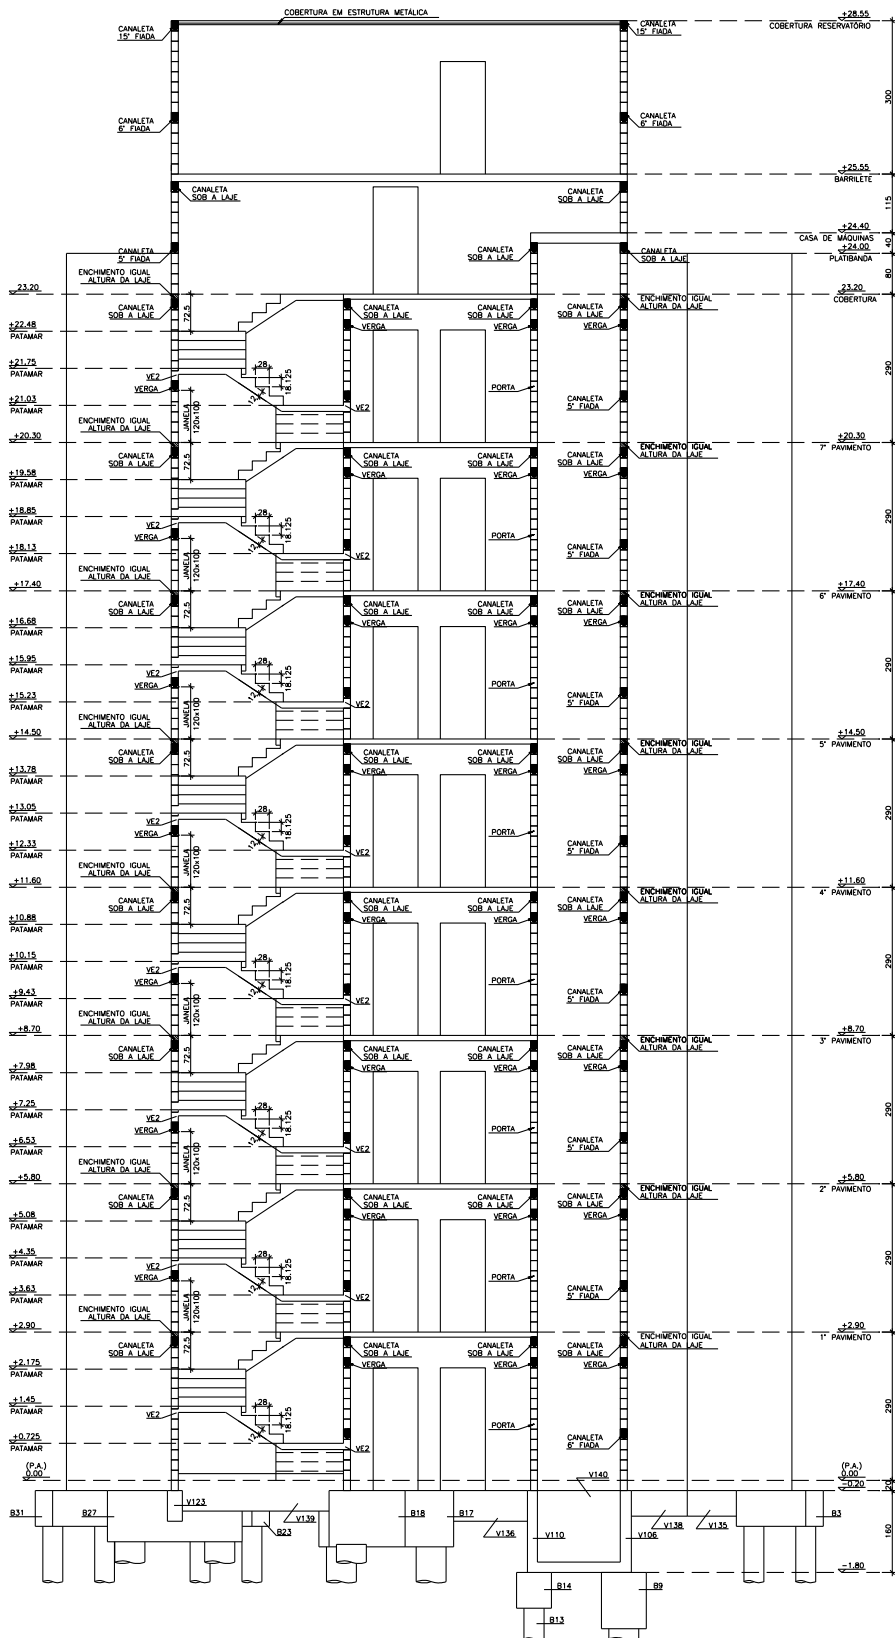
CORTE GERAL DO EDIFÍCIO. OPÇÃO: ALVENARIA ESTRUTURAL
